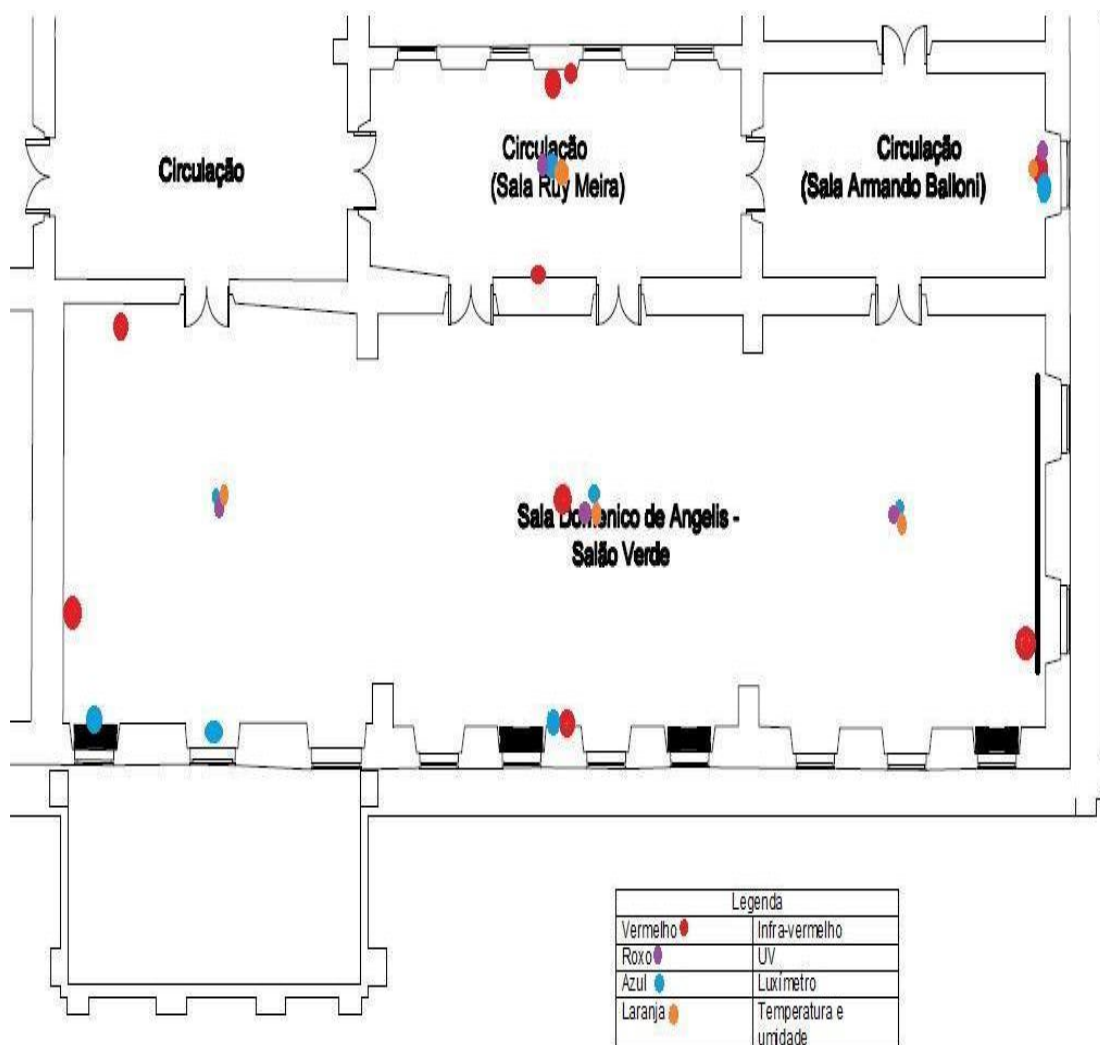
Planta Baixa com localização dos pontos escolhidos para medição.
